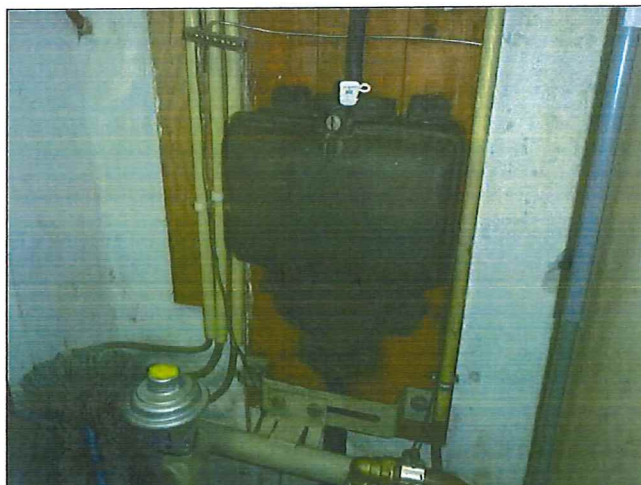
Trapkast: Hoofdzekeringkast (Ontoegankelijk)
